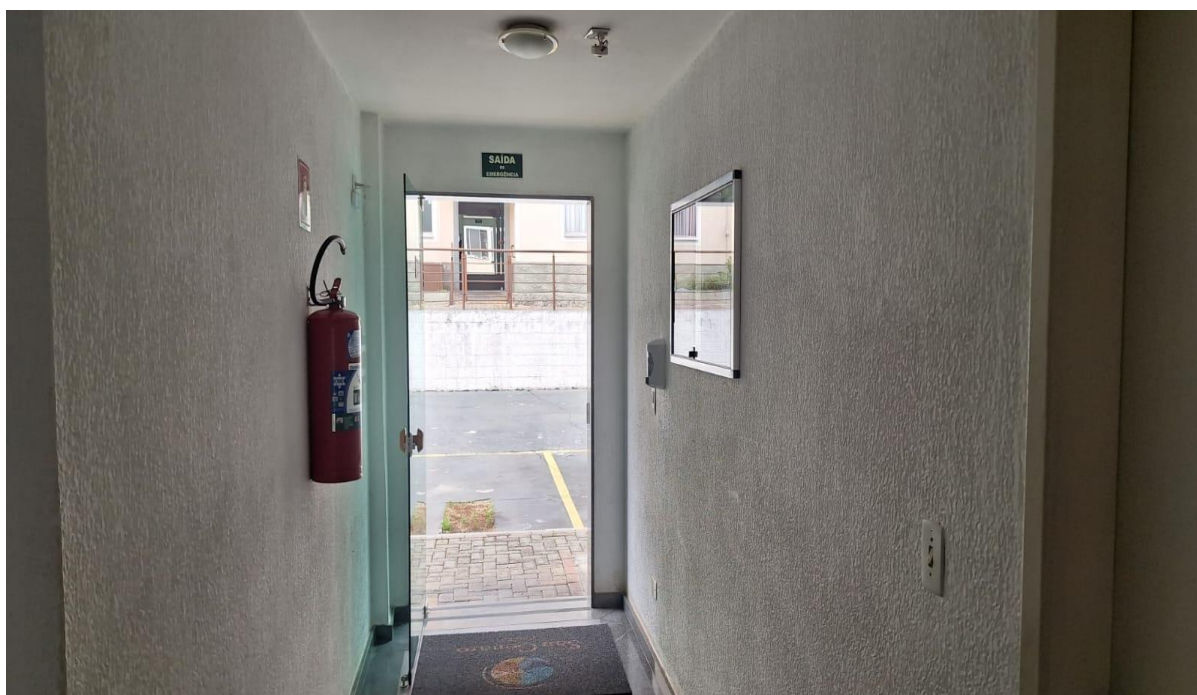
Hall de entrada – Bloco 2 – pavimento térreo
